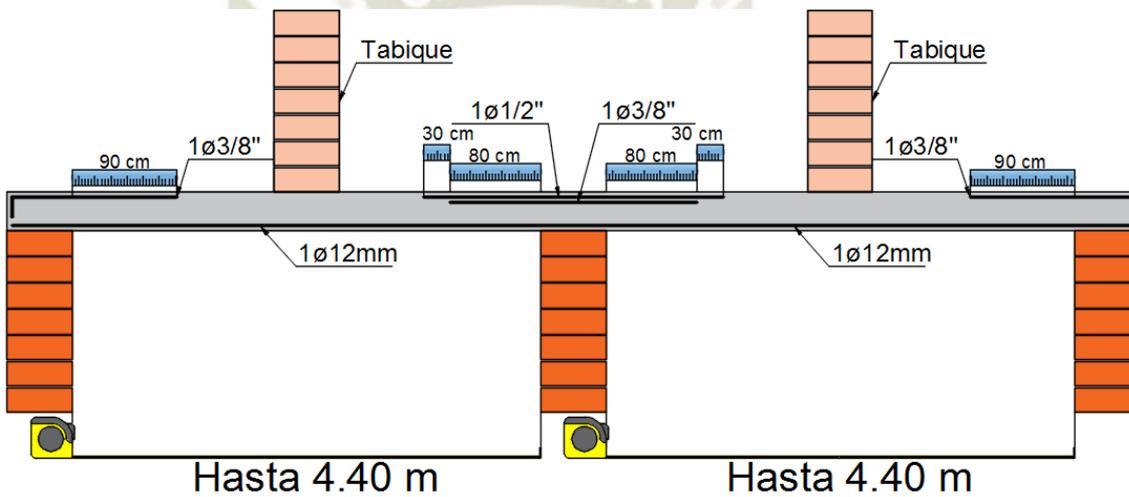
Refuerzo de vigueta hasta 4.40 m por tramo, con tabique encima.
